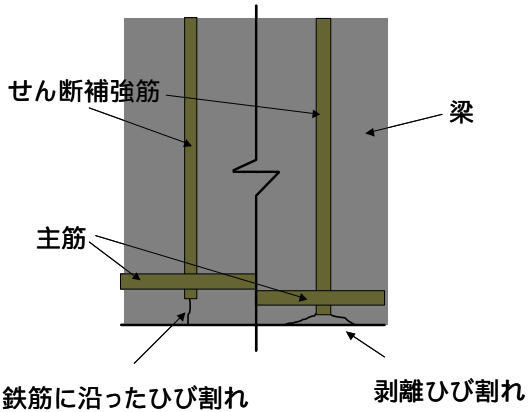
表面はく離と鉄筋に沿ったひび割れ
